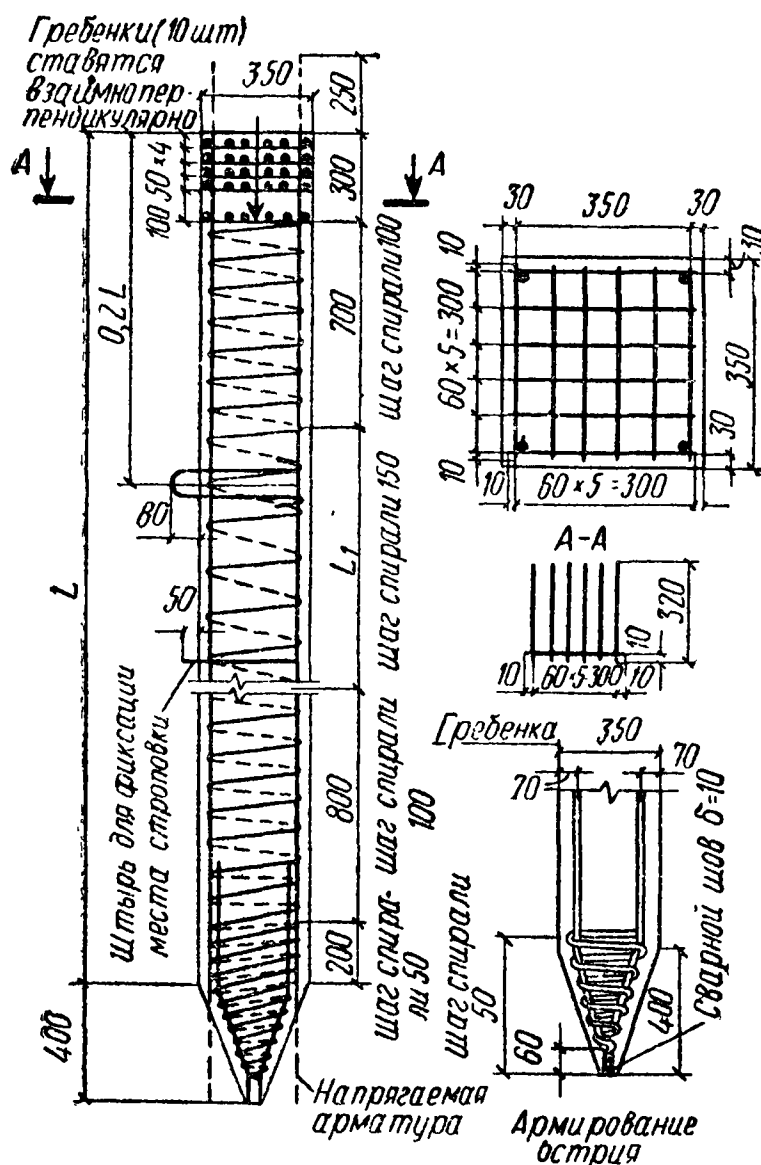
Железобетонная свая квадратного сечения с предварительно-напряженной стержневой арматурой
